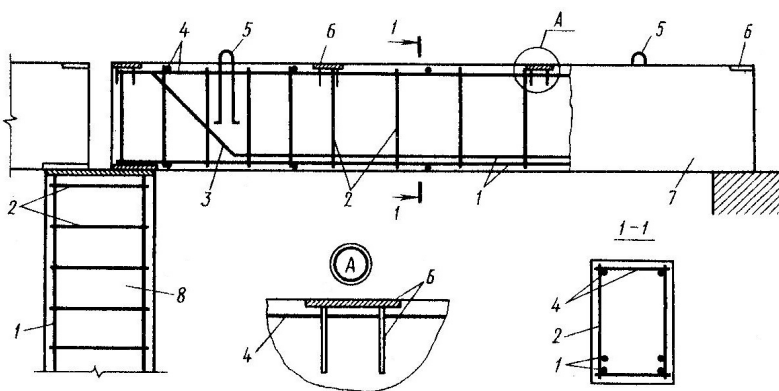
Арматура железобетонных элементов: 1 – продольная арматура; 2 – хомуты; 3 – отогнутые стержни; 4 – монтажная арматура; 5 – монтажные петли; 6 – закладные детали; 7 – балка; 8 – колонна
